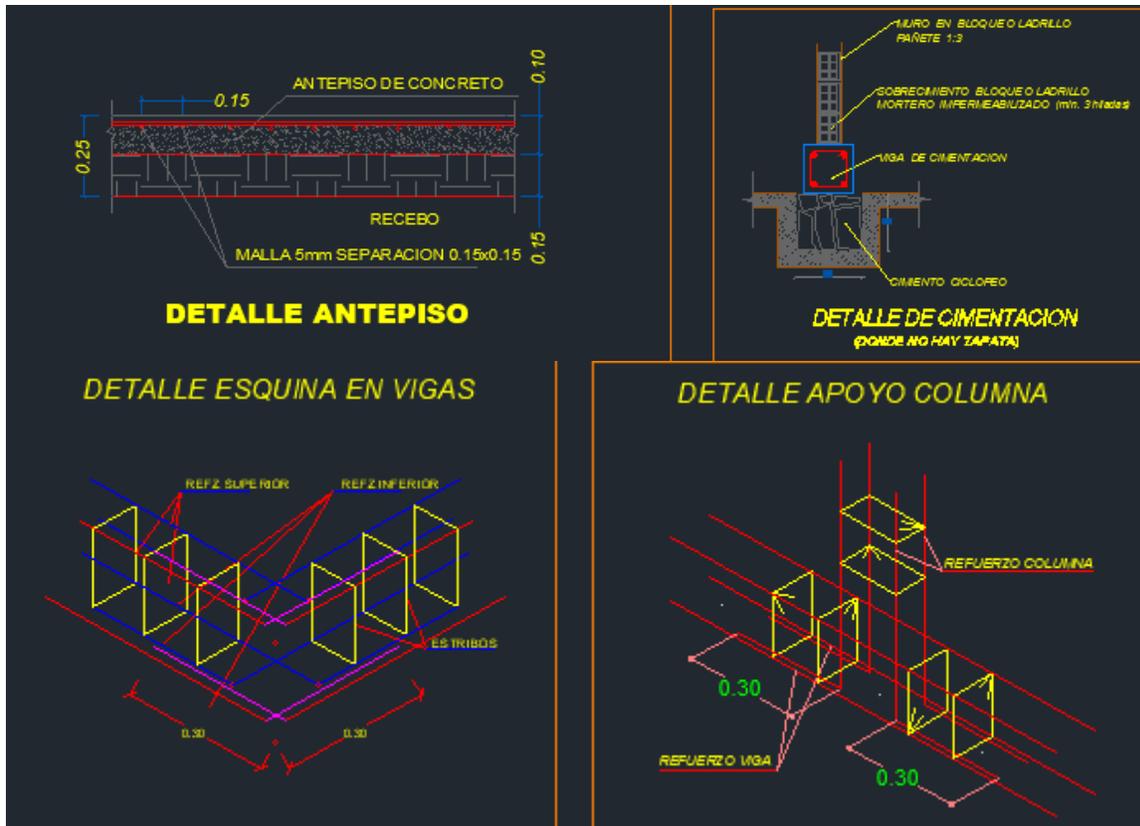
detalles de la estructura en cimentación y de ante piso y detalles en vigas y apoyo en la columna
